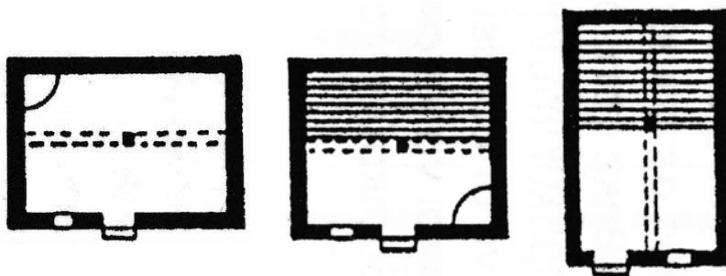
Varianten des Hauses mit zentralem Balken und Stütze: Grundriss-Schemata
